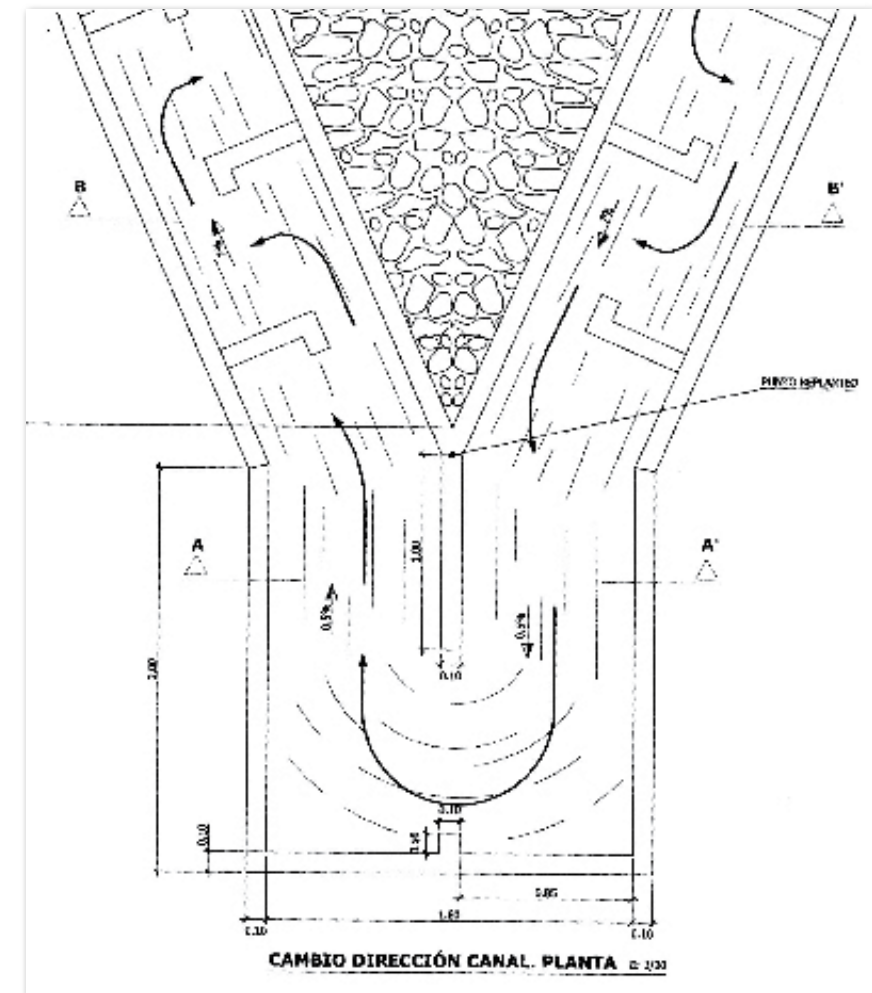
Detalle de la escala para peces de la presa de Los Melonares. Planta
